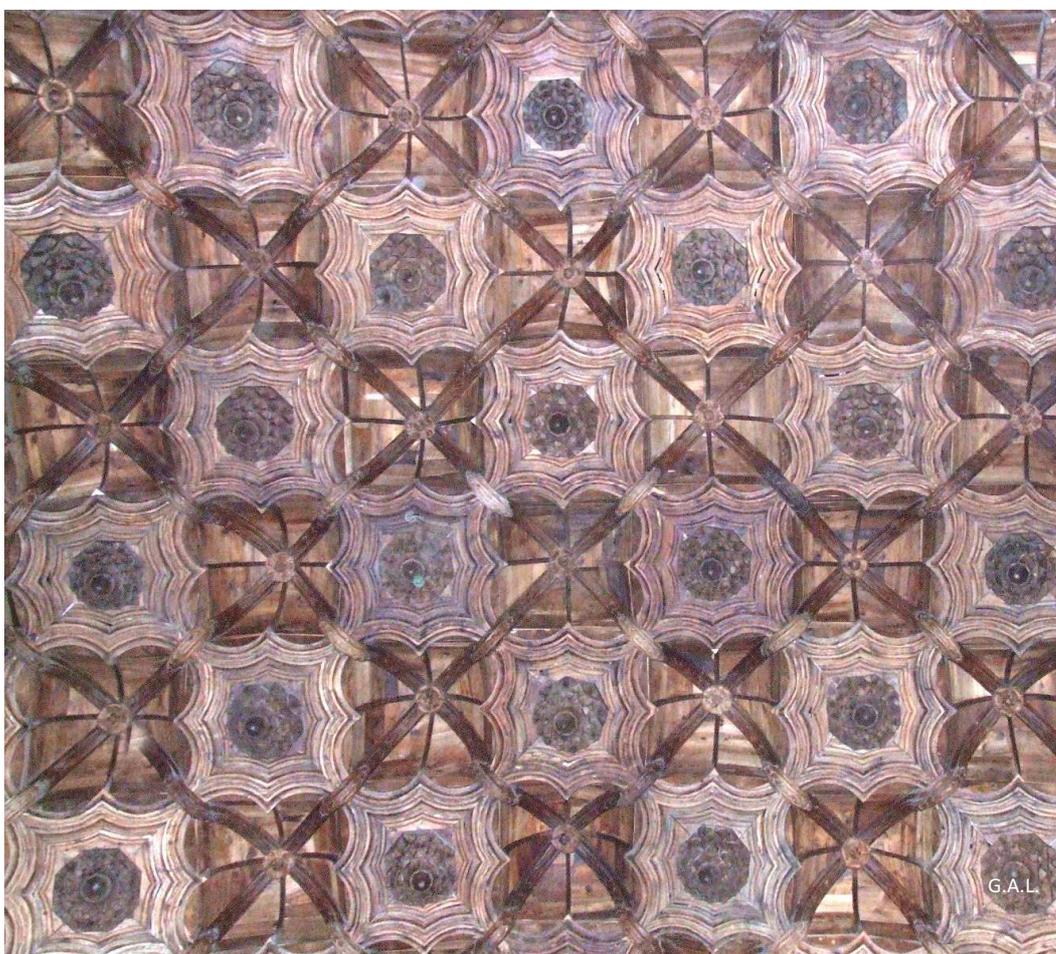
detalle de la armadura del crucero donde se aprecia la superposición de las dos retículas que forman la armadura. 2008.
